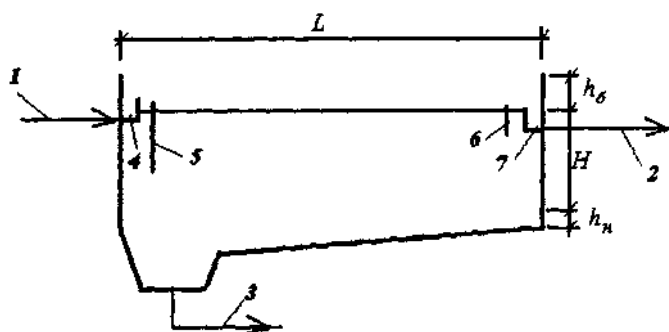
Розрахункова схема горизонтального відстійника:
